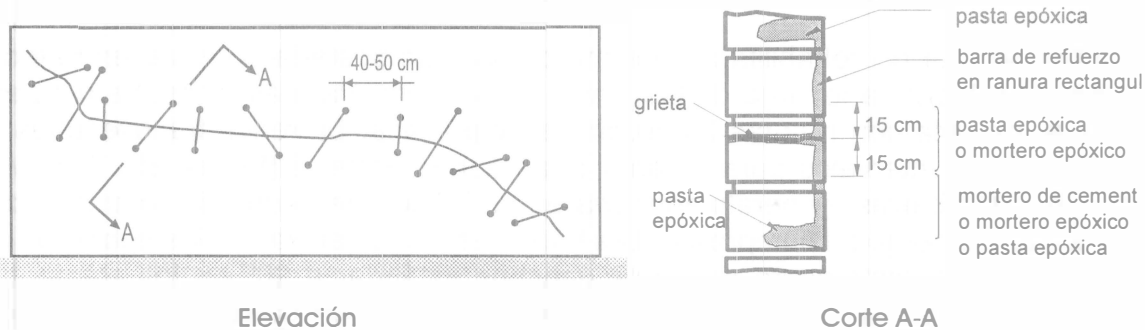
Colocación de grapas sobre grietas en muros de mampostería.
